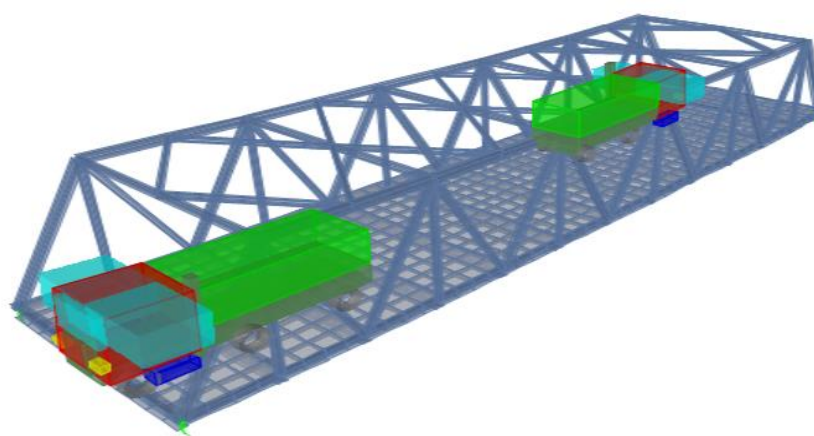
Vista en 3D de la armadura metálica final + losa de concreto armado + vehículo
